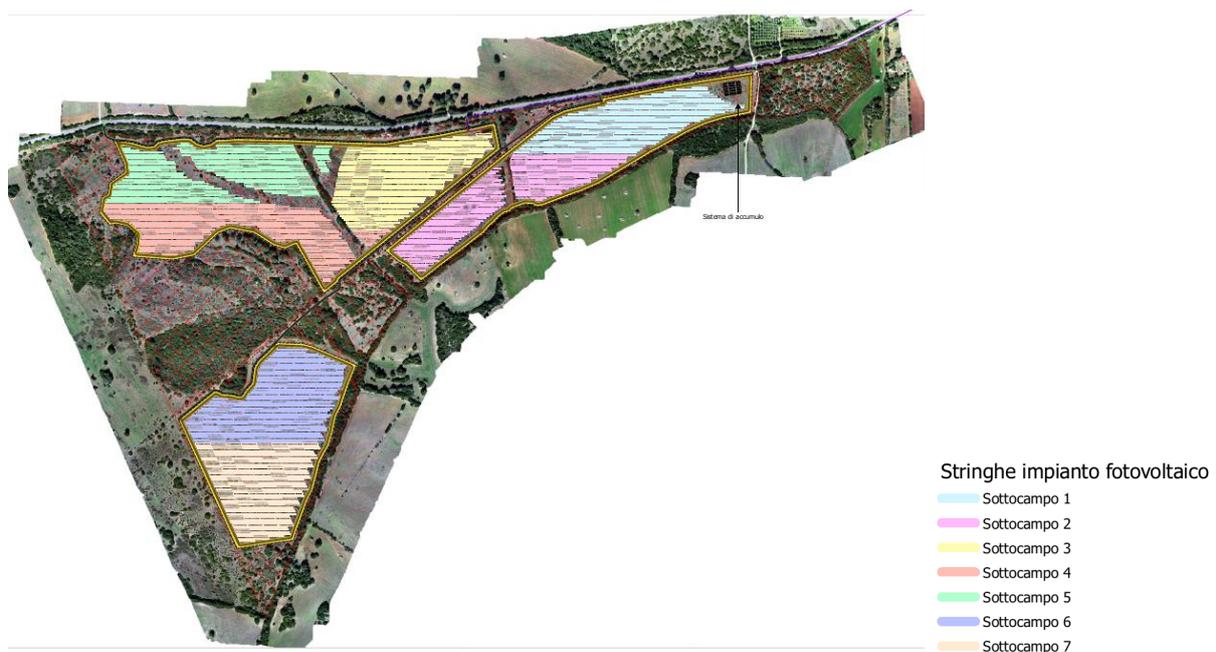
Dettaglio suddivisione in sottocampi (estratto di PRO\_TAV\_8)
